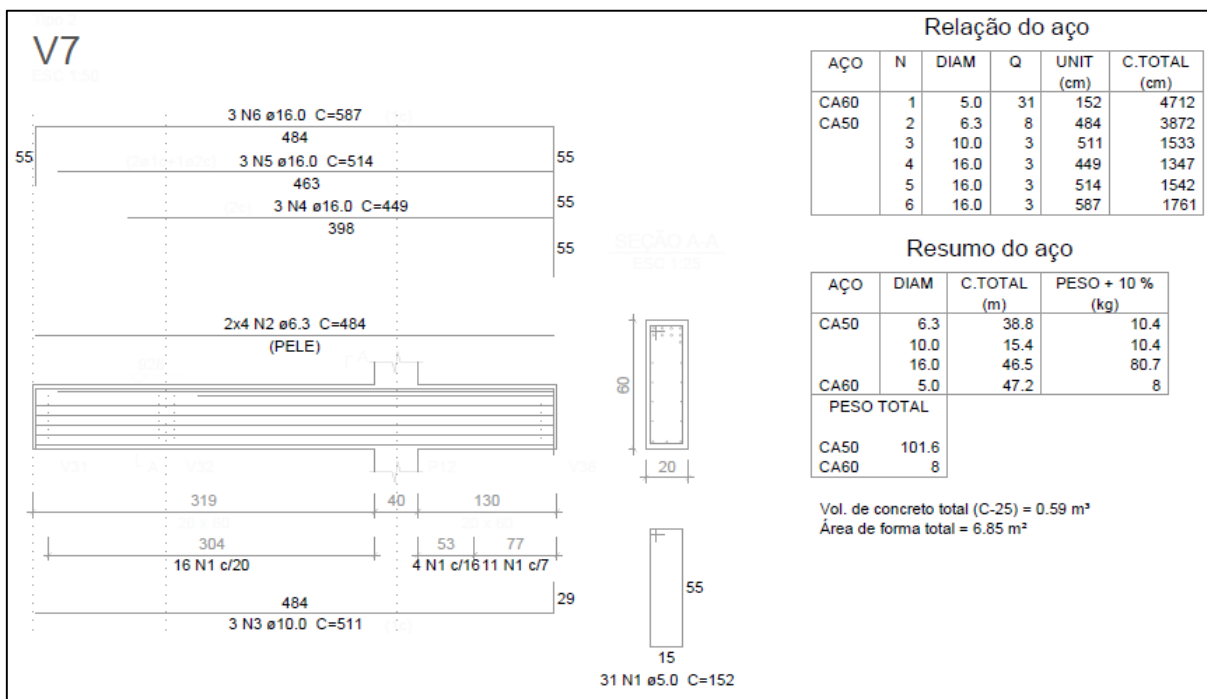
Detalhamento da Viga V07 no projeto com alvenaria
